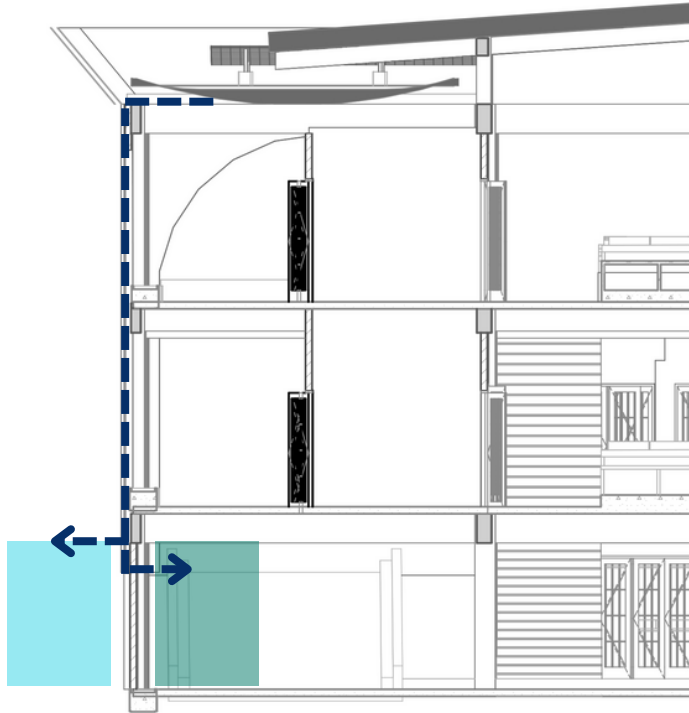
Skema aliran Arus Listrik dari Panel Surya ke Ruang Baterai
